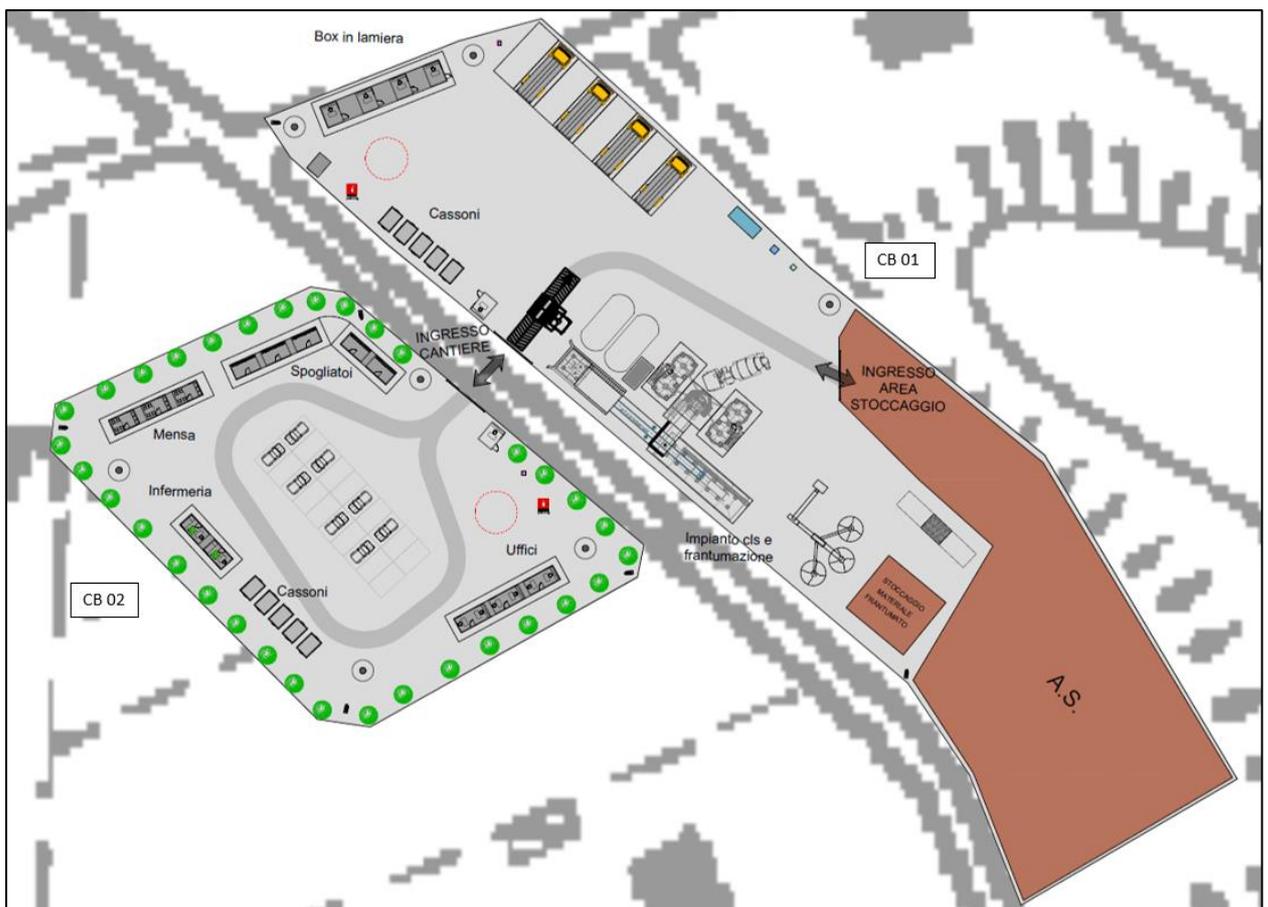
Layout cantieri base CB 01 e CB 02
